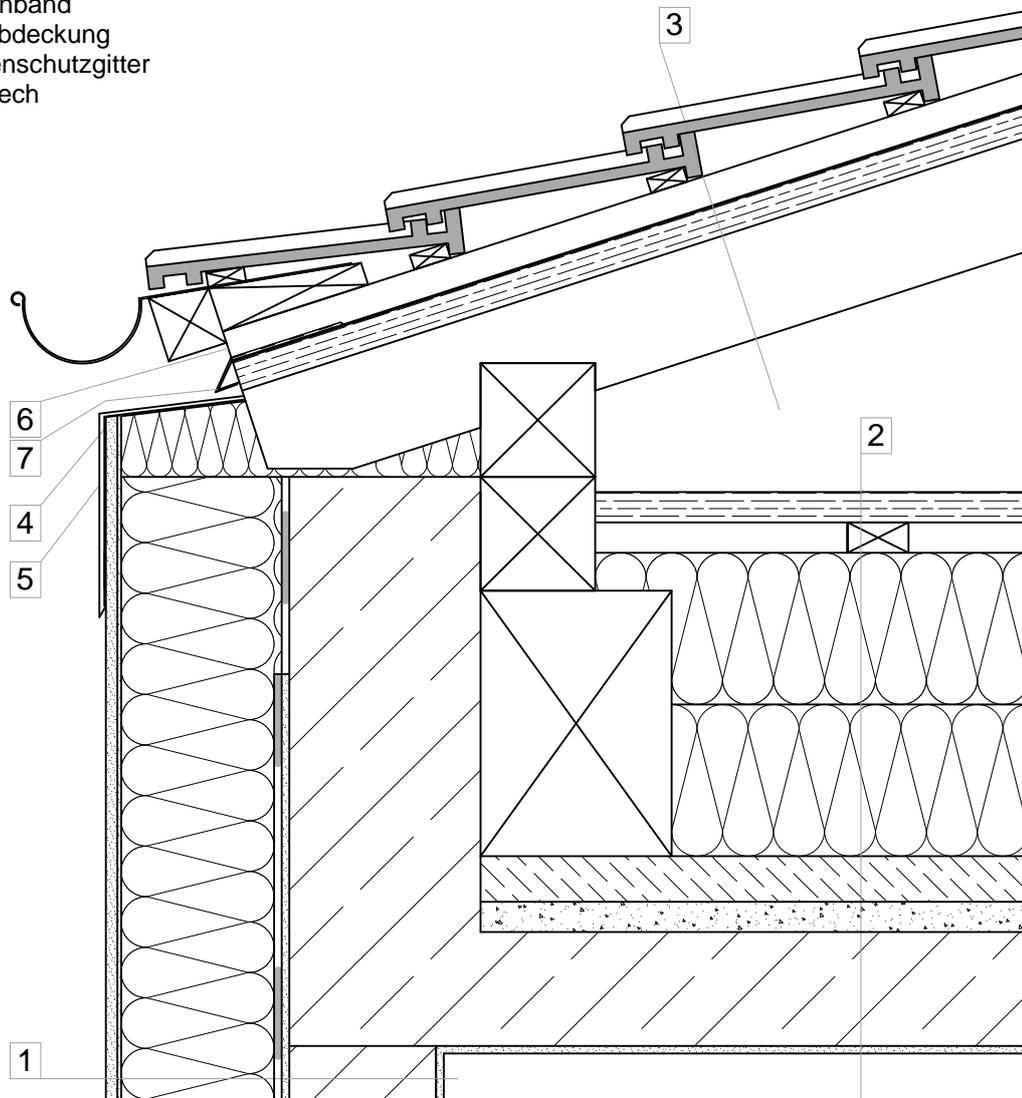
Detail Dachanschluss + oberste Geschoßdecke M1:10 [Quelle: eigene Darstellung]
